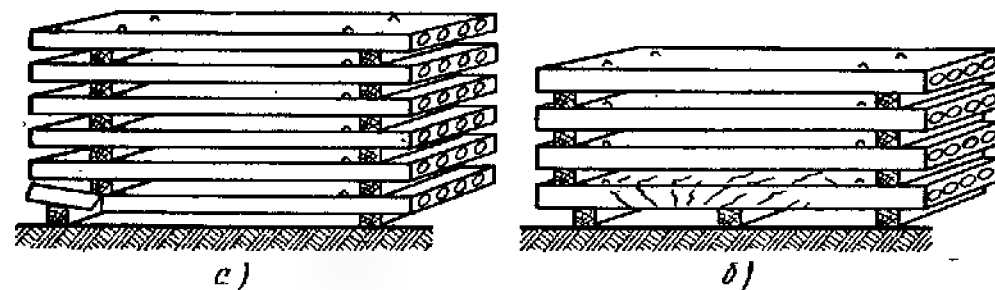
Разрушение железобетонных плит при неправильном складировании:
